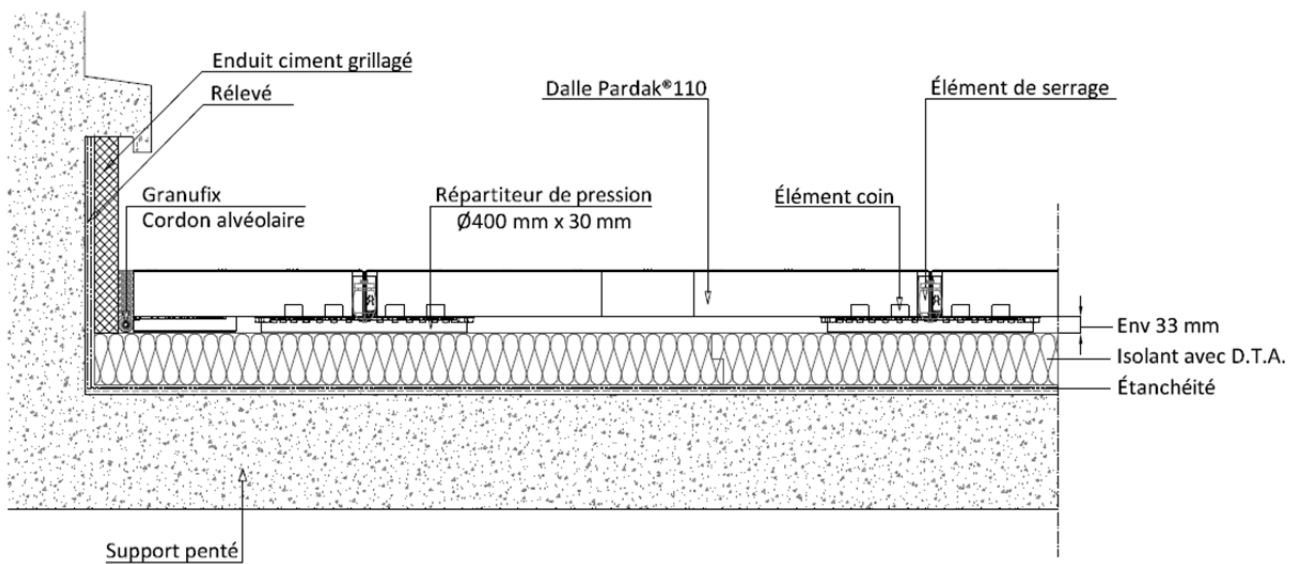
Coupe sur relevé, avec panneaux isolants supports et revêtement d'étanchéité à base d'asphalte
